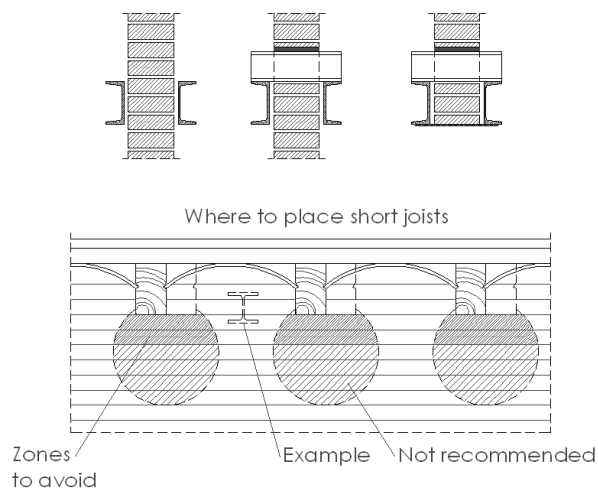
Zonas de emplazamiento de asillas bajo forjados de viguetas. Fuente: Sanabra (2020).
